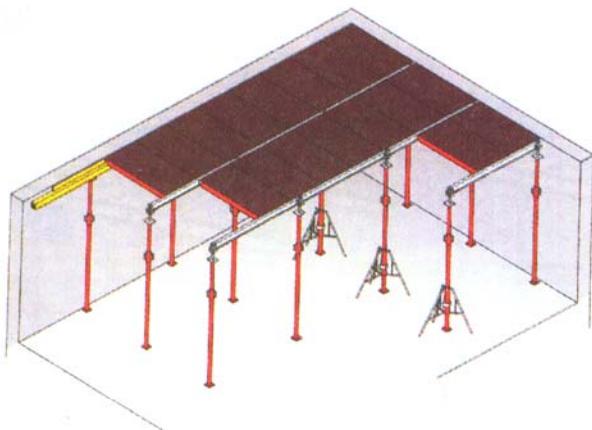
Опалубка перекрытий фирмы «НОЕ» с раздвижными телескопическими второстепенными балками и «поворотной головкой»
